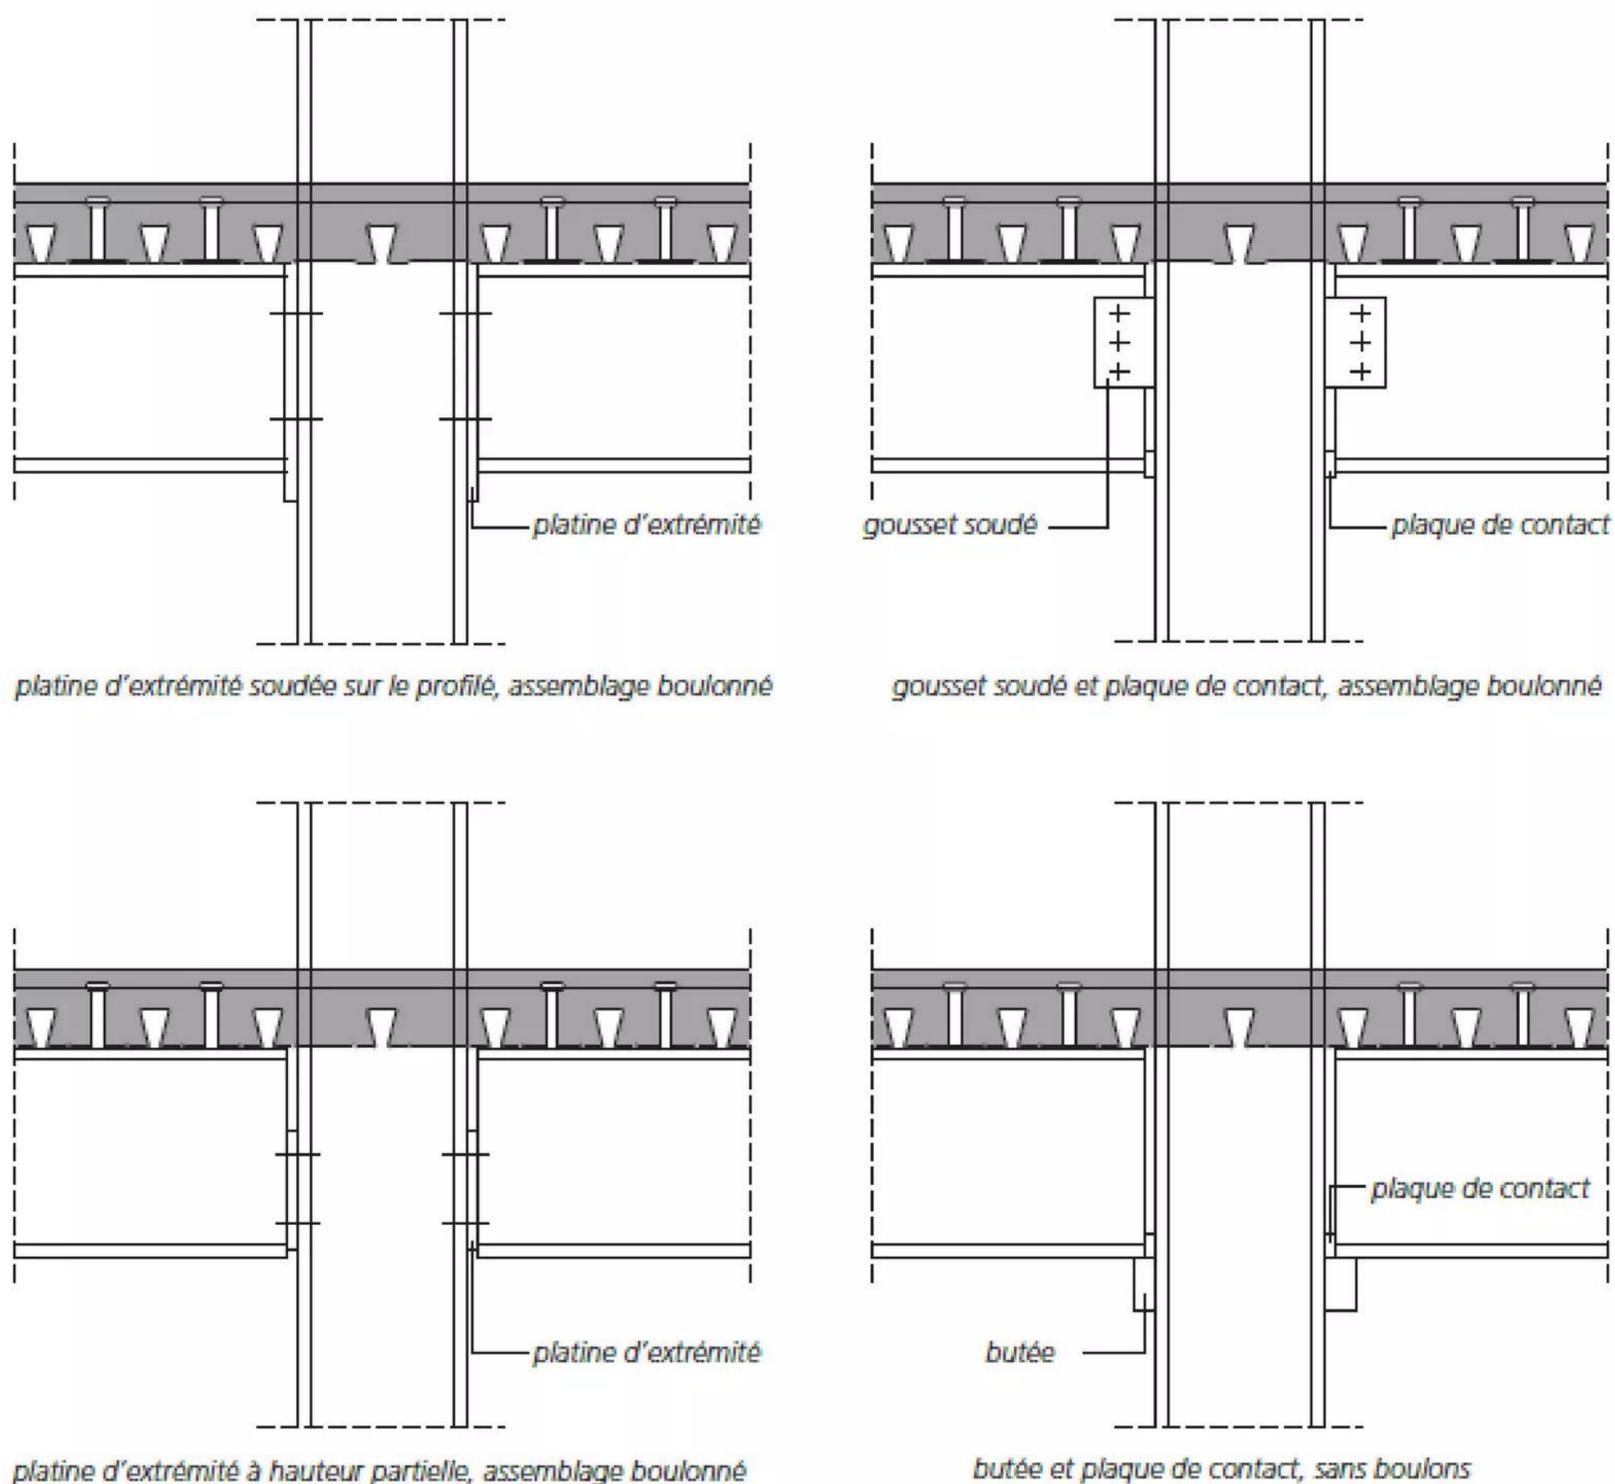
Quelques exemples d'assemblages poutre-poteau en construction mixte
